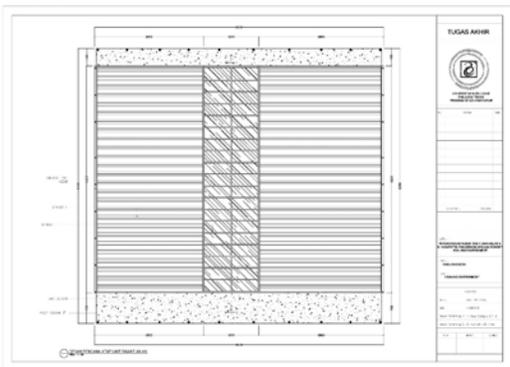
Denah dan Tampak Atas Bangsal Rawat Inap Kelas 3
